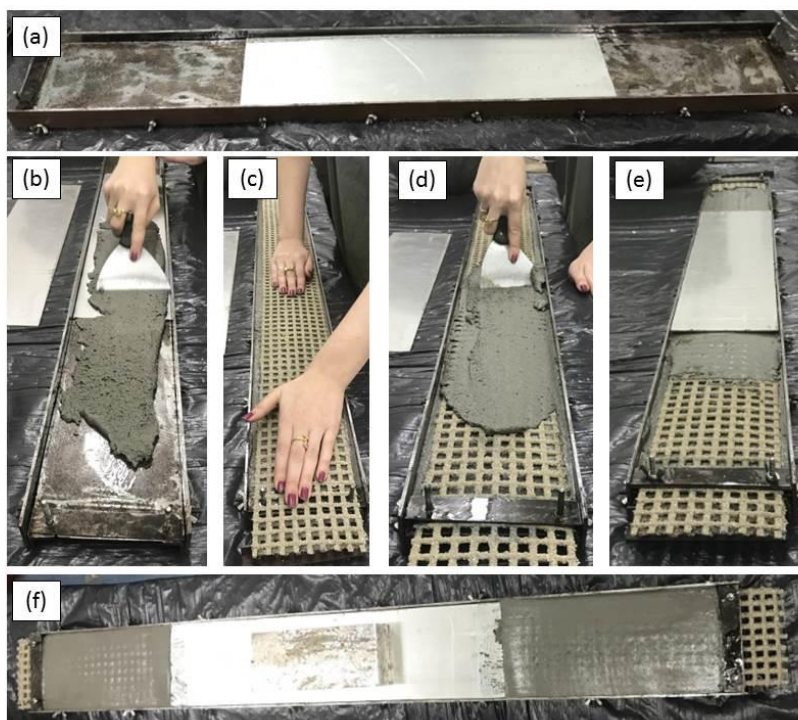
Fabricação das placas para ensaio de tração direta.
